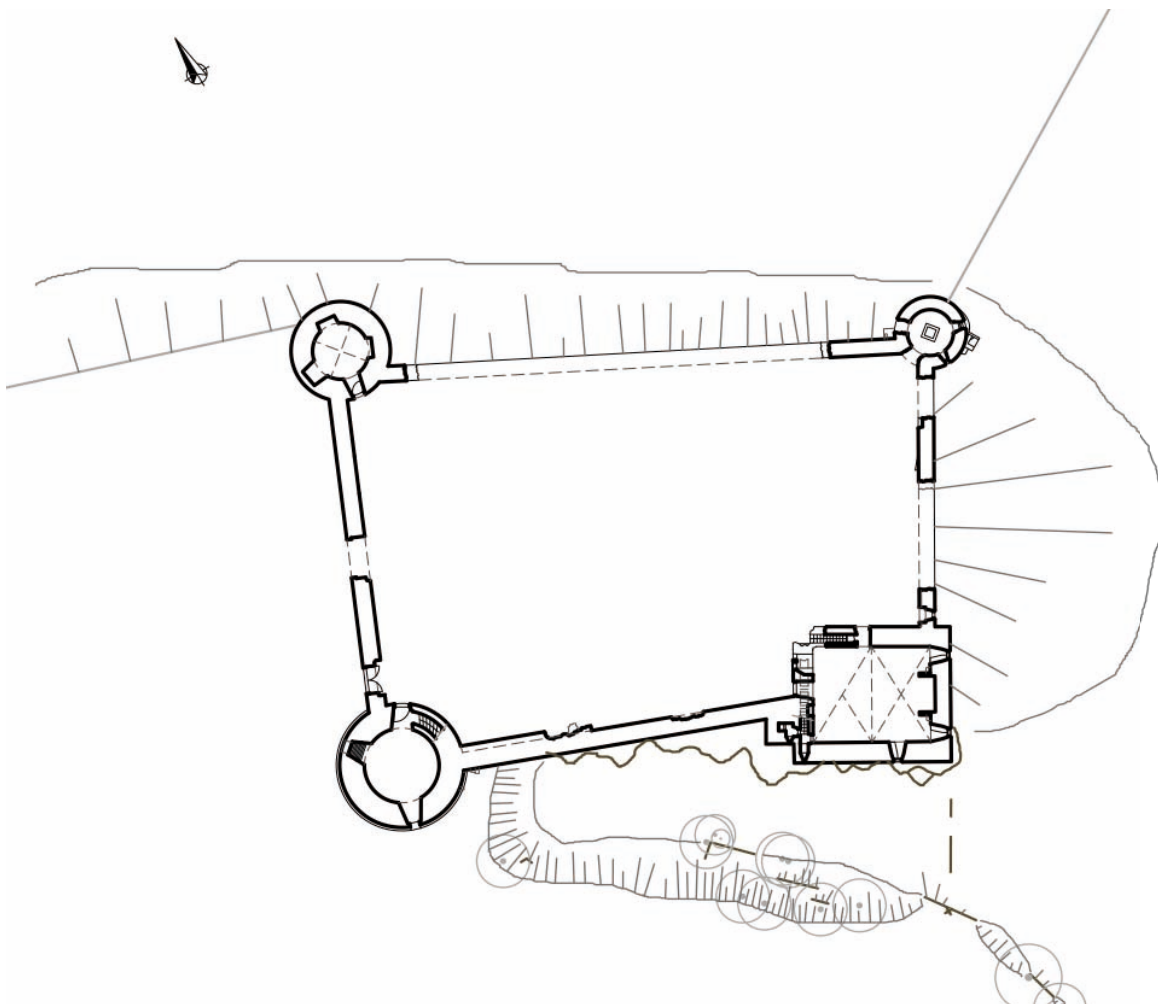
Plan de masse (P. Raynaud)
